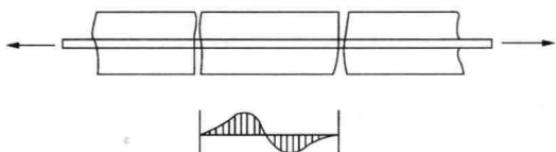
钢筋和混凝土之间的粘结应力示意图（错）
